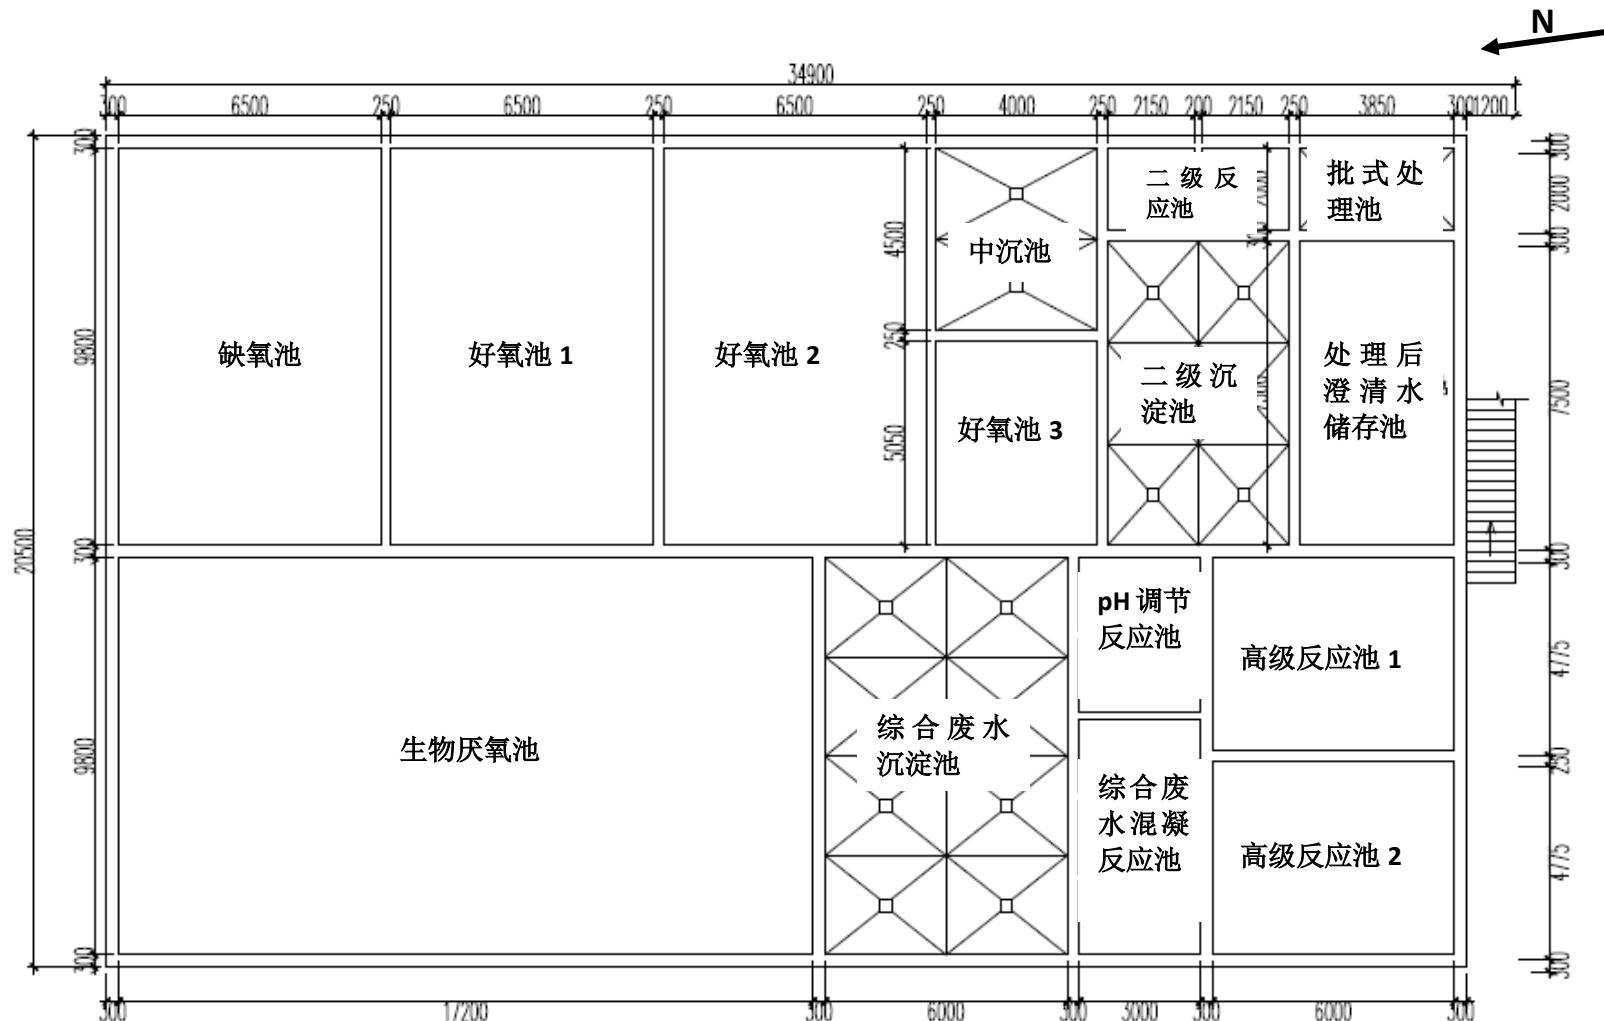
处理构筑物1二层平面布置图（0.8~6.1m）
